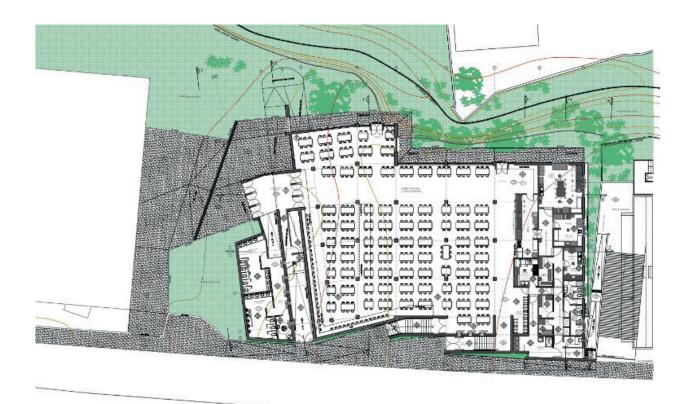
Planta del proyecto. Fuente: Elaboración propia
